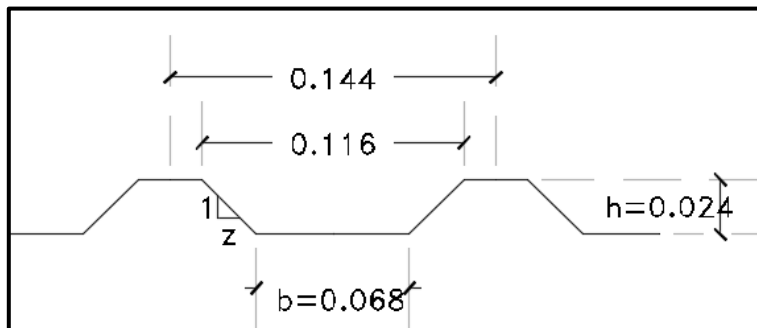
Geometría de del canal de la lámina en estudio (autoría propia, 2021)
